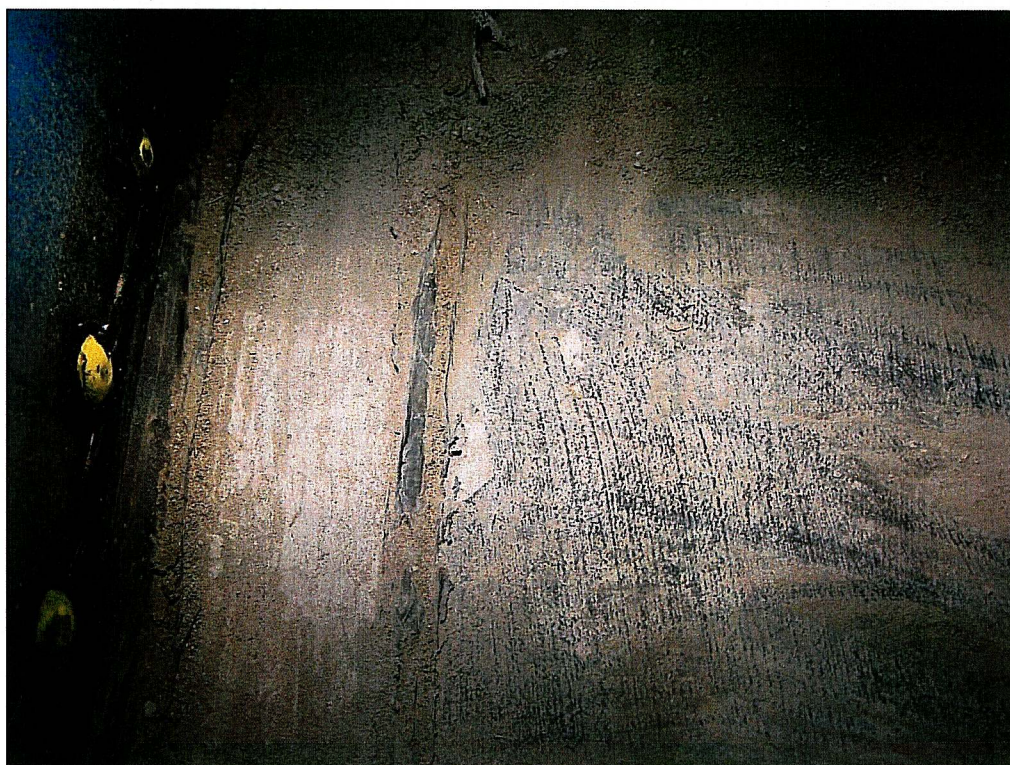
Zluszczająca się warstwa izolacyjna, brak zabezpieczenia betonu w rowku kotwiącym
